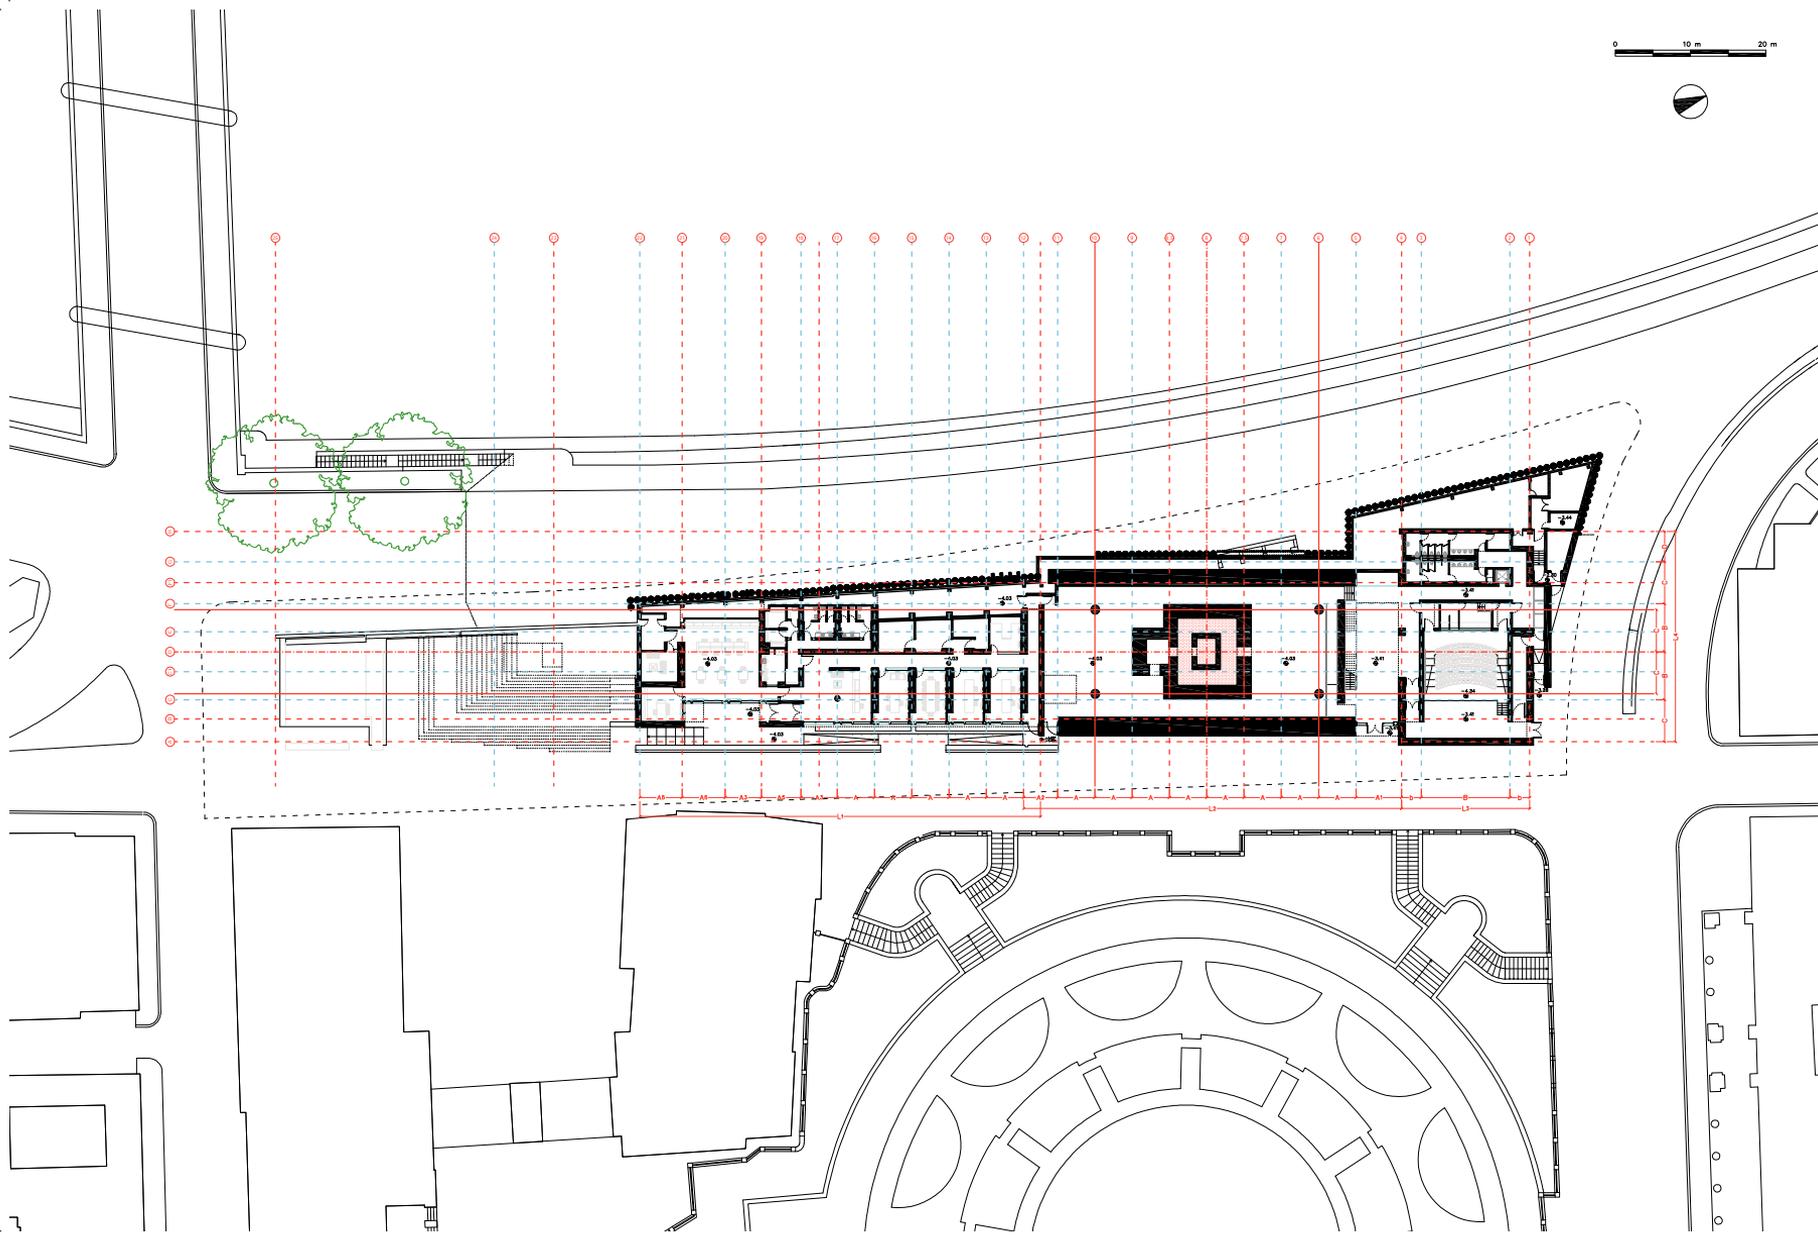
Museo dell'Ara Pacis, Roma, pianta piano mezzanino con individuazione del sistema di modulazione.
